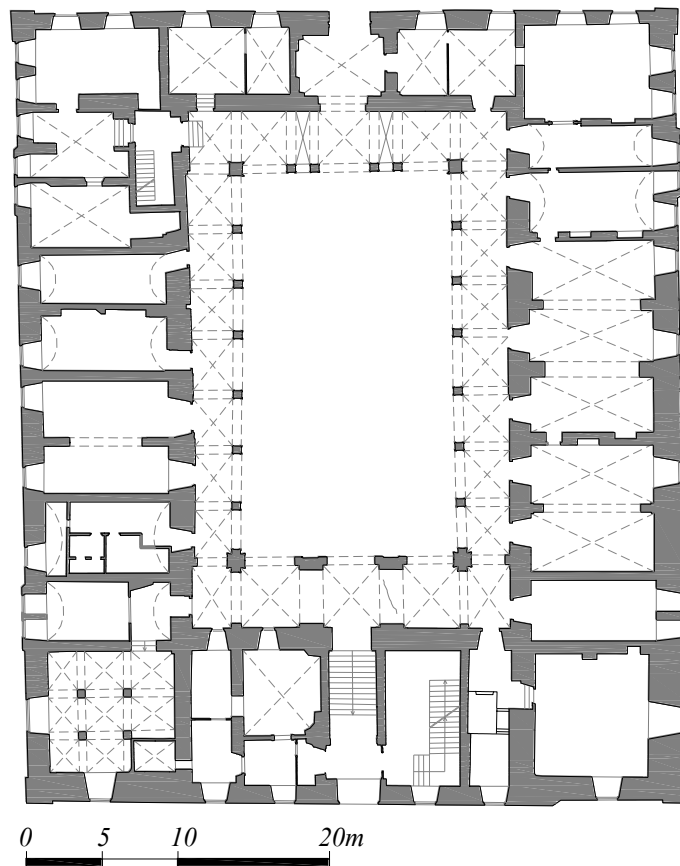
Scuola Elementare De Amicis, L'Aquila: Pianta piano terra
